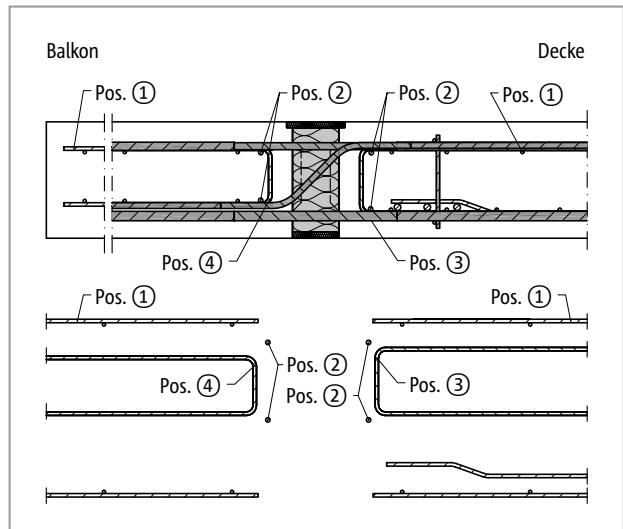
Schöck Isokorb® T Typ K-M13 bis M14: Bauseitige Bewehrung bei indirekter Lagerung
